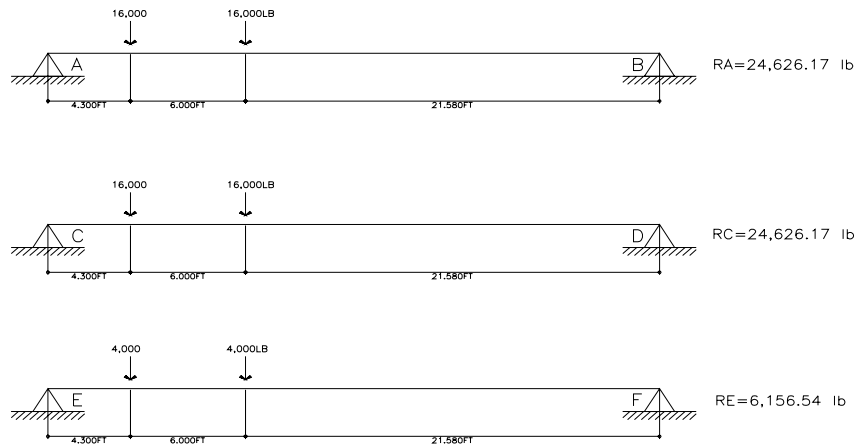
Planta estructural con ubicación de vehículo virtual en puente Chiquimulilla
